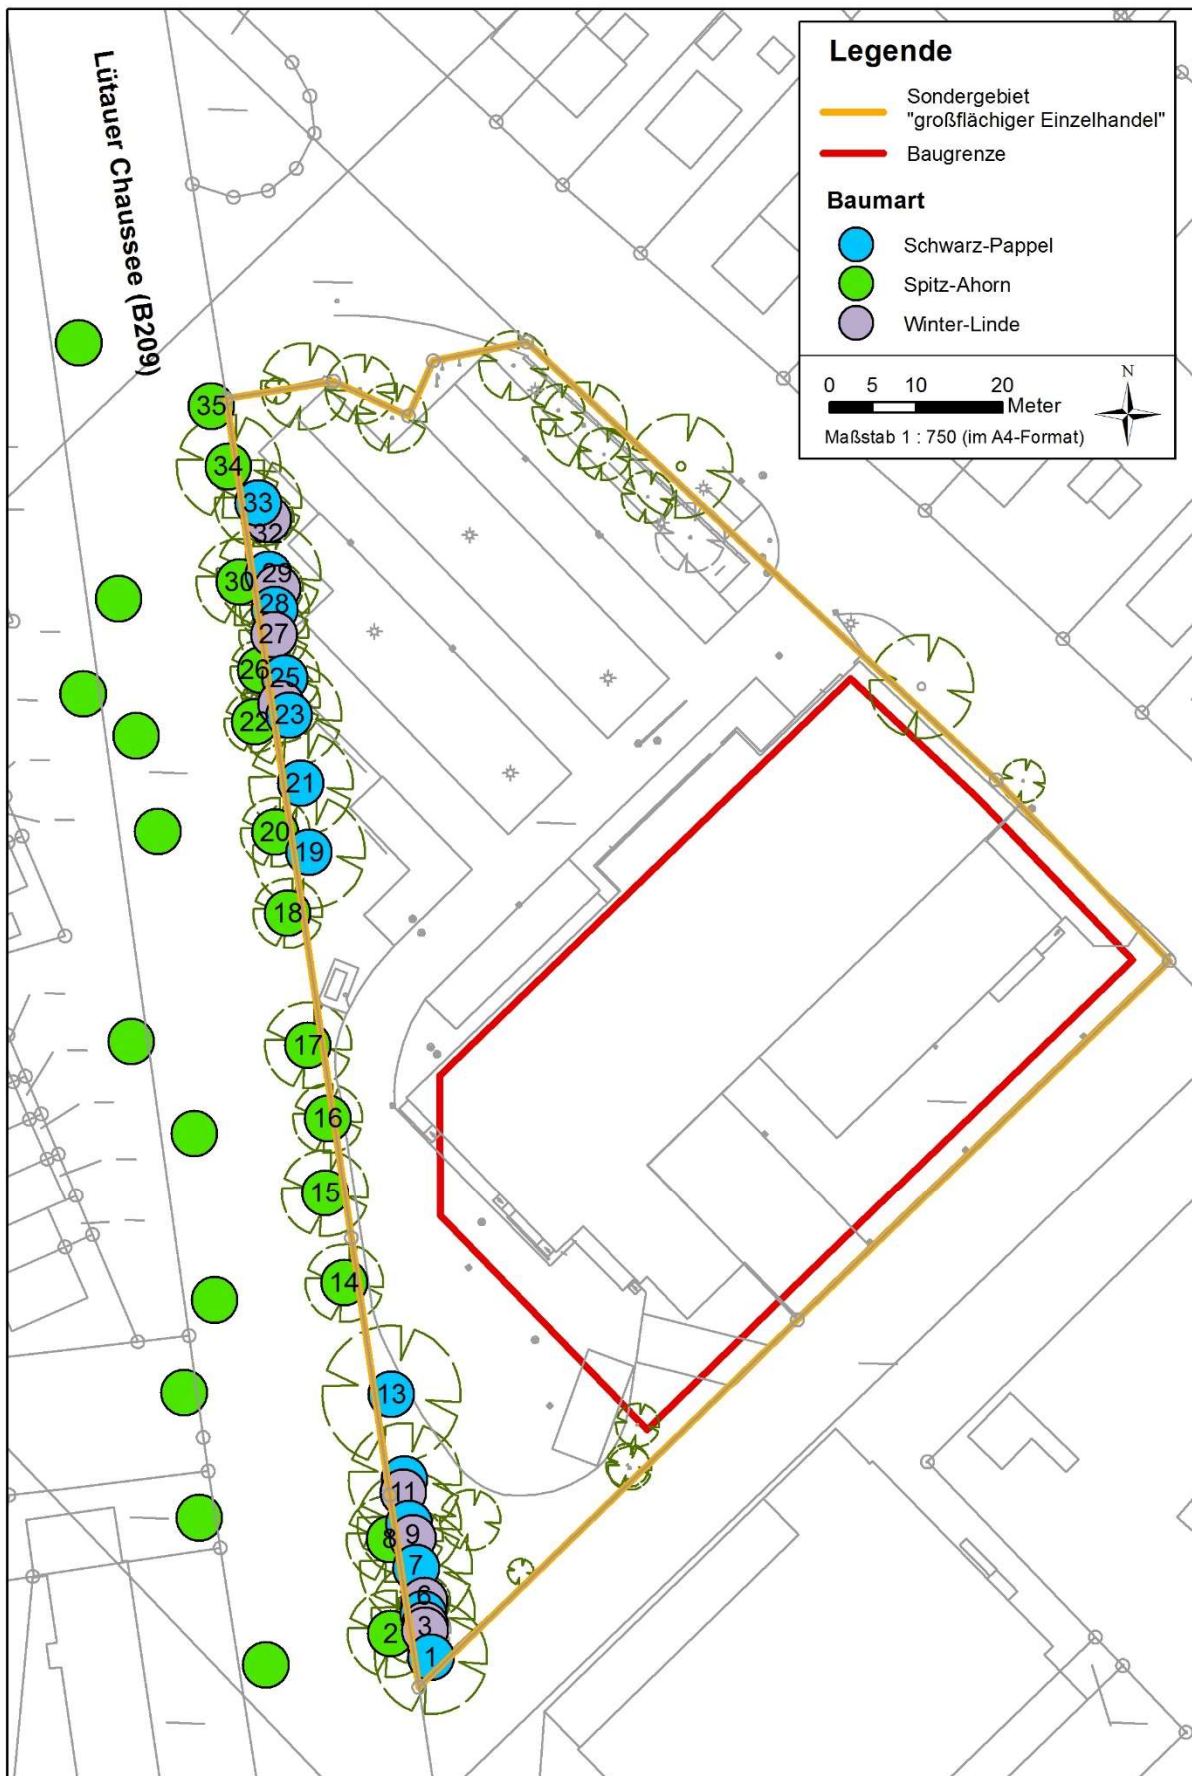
Lageplan Baumbewertung Alleebäume (grün)
